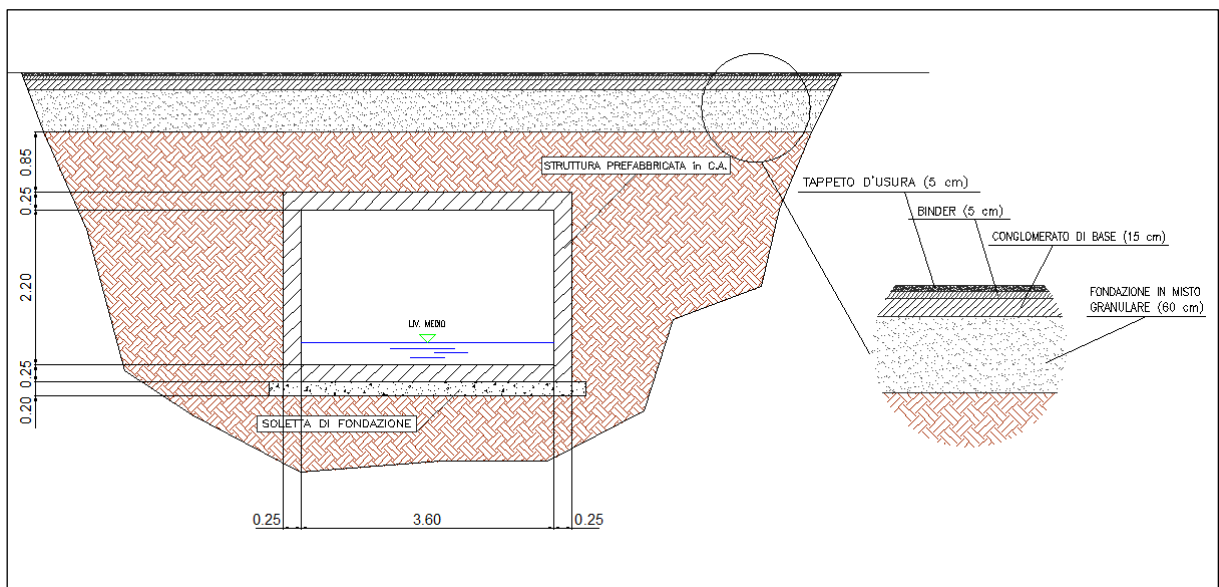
Sezione tipo della tombinatura prevista per la seconda soluzione progettuale
